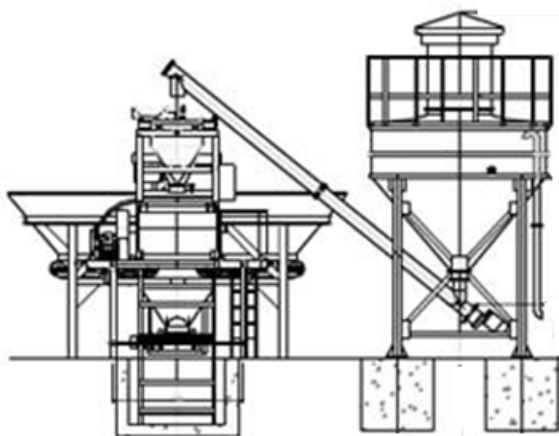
Двоступенева бетонозмішувальна установка на будівельному майданчику
